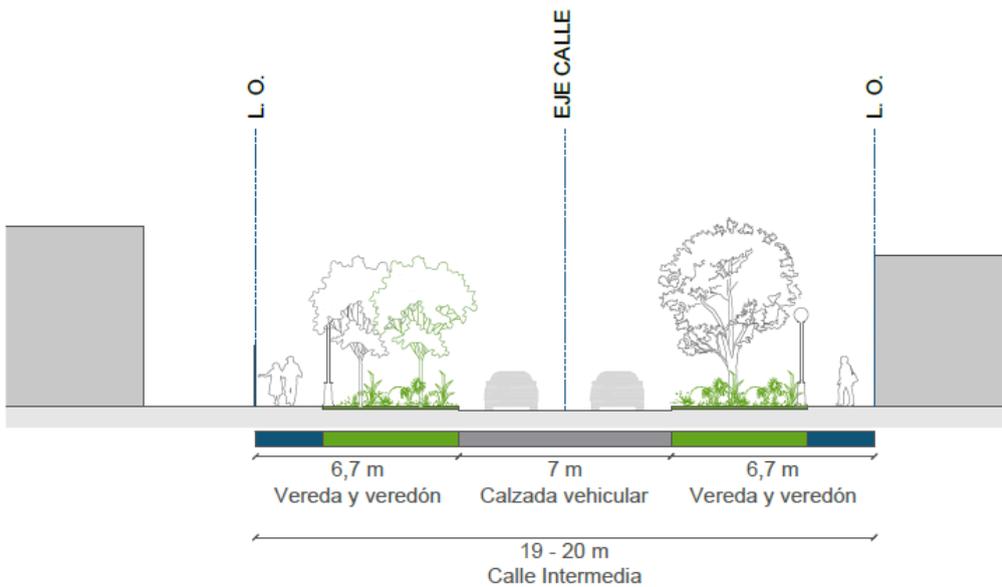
Perfil tipo. Situación propuesta Calles Intermedias.
